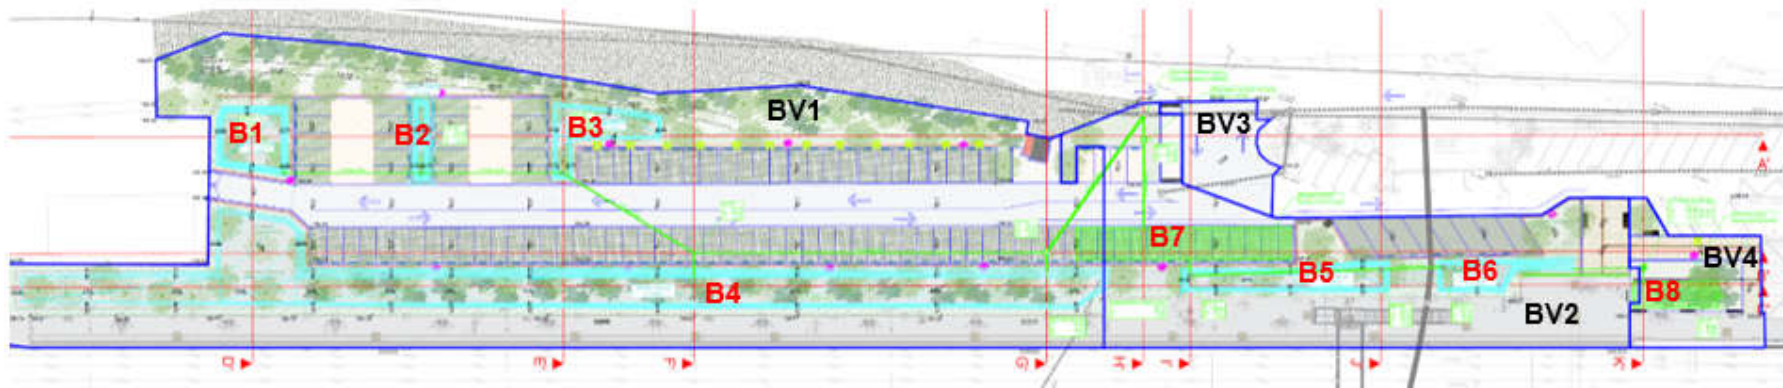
Plan d'assainissement du projet sur le secteur gare
